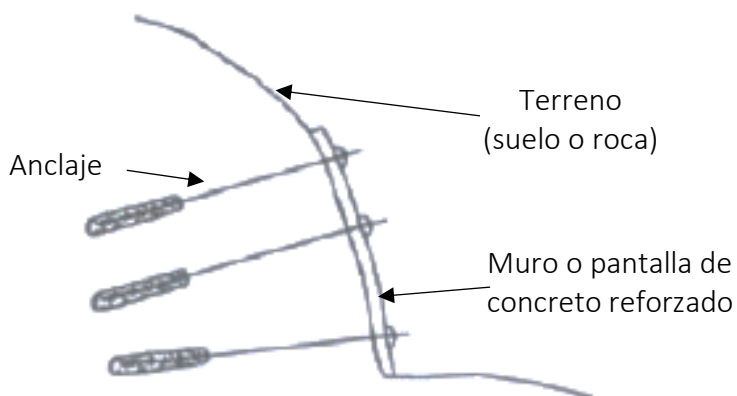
Estructura anclada de pantalla anclada. Fuente: ACG (2009)
